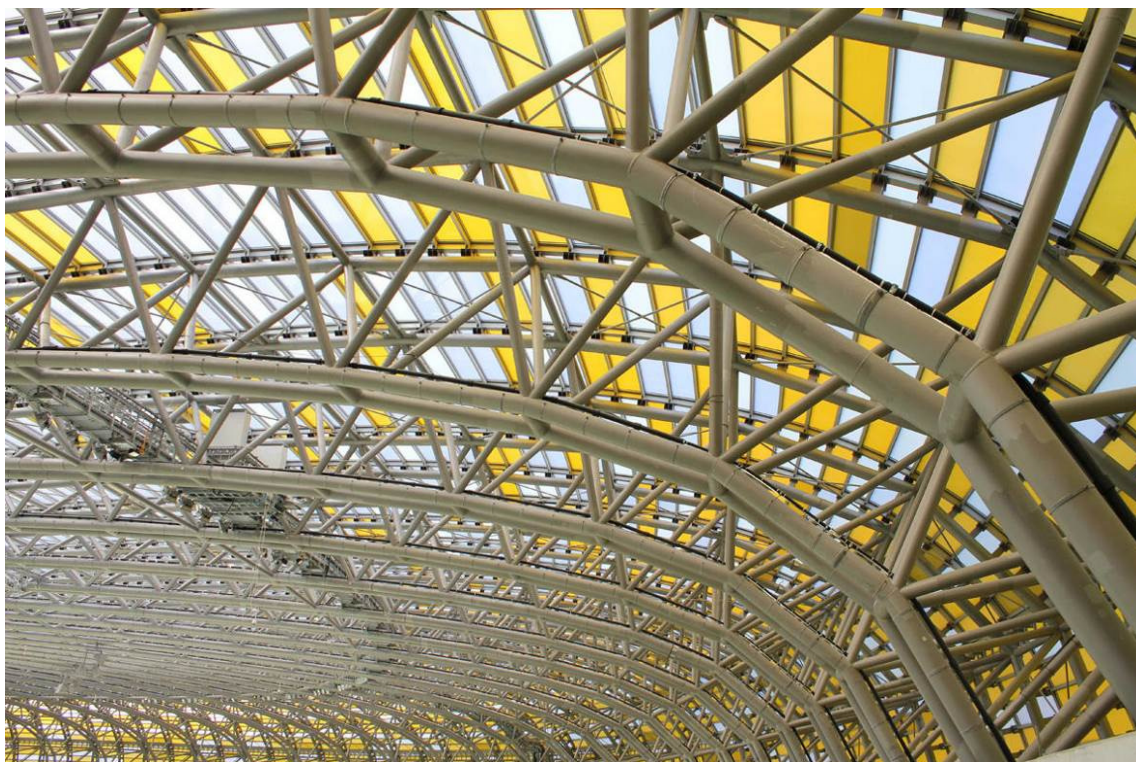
Консольно-рамные системы навеса над стадионом в Гданьске из труб круглого сечения
